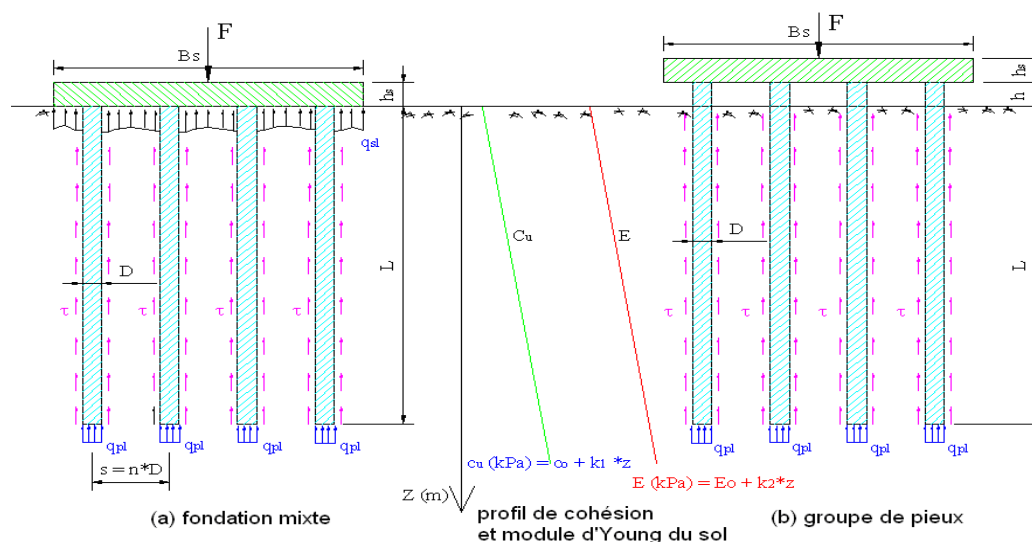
Fondation mixte (a) et Groupe de pieux (b)
